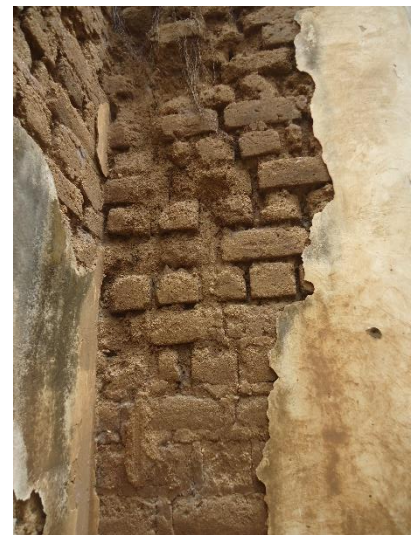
Pared de mampostería de adobe. Fuente: Elaboración Propia.
